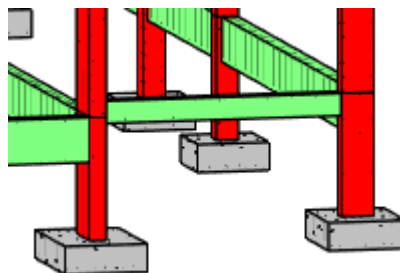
Alteração nas dimensões da viga 5 baldrame
